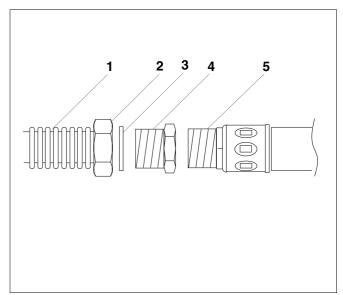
Collegamento del tubo ondulato in acciaio inox all'accumulatore con attacchi da R¾
